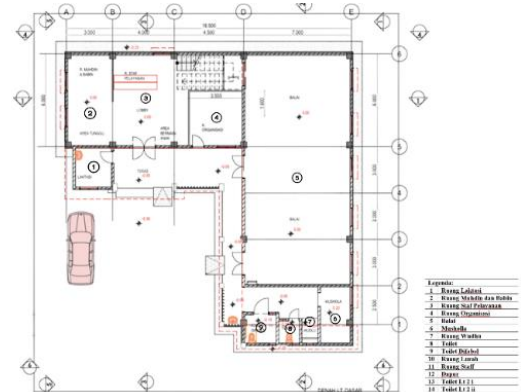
Siteplan Kantor Kelurahan Barusari.
